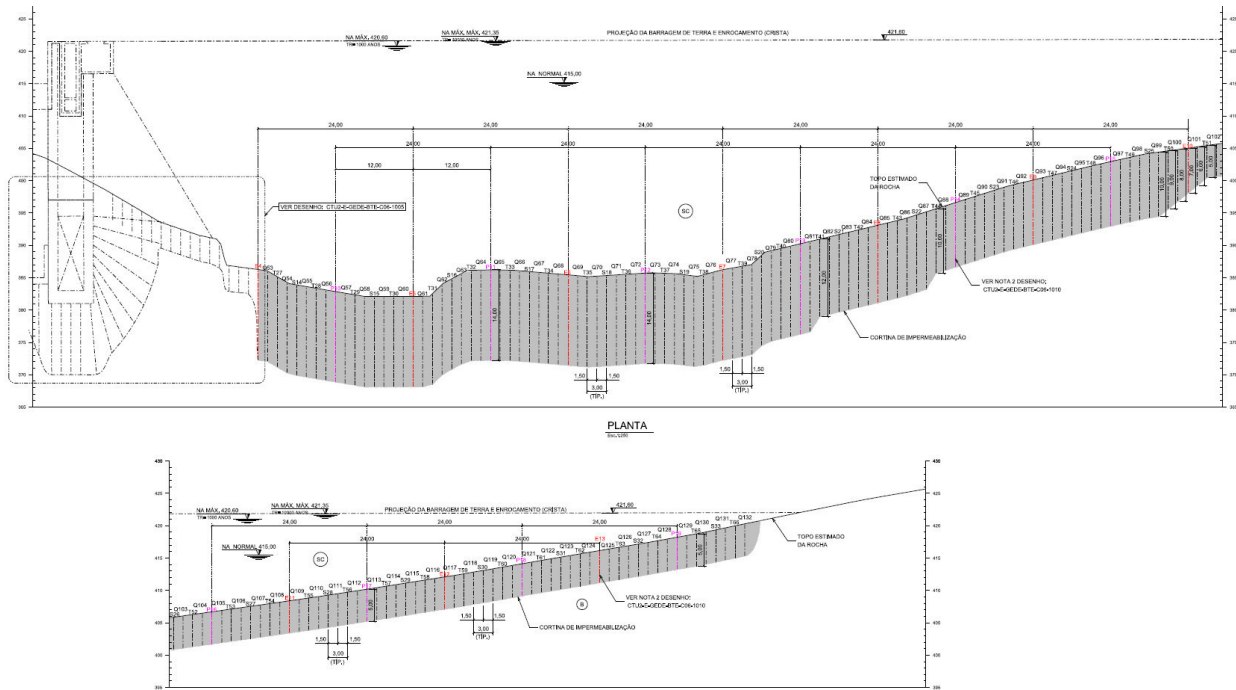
Cortina de injeções de impermeabilização ao longo do barramento
